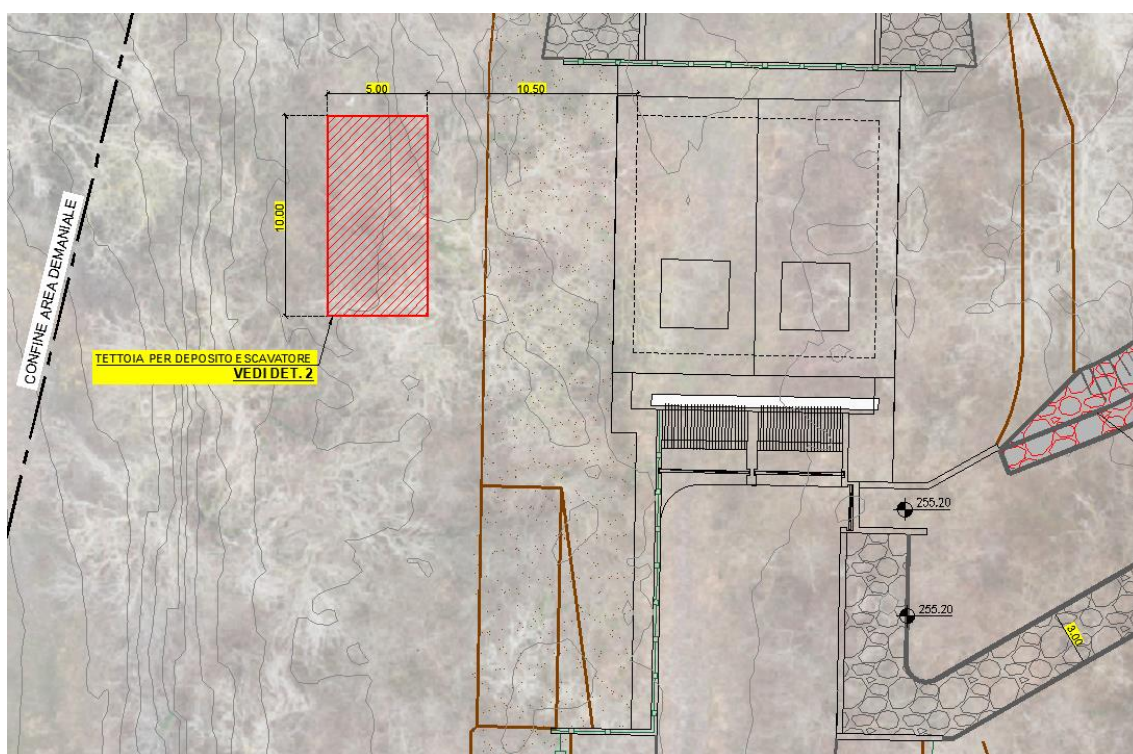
Area di installazione della tettoia per il deposito dell'escavatore
